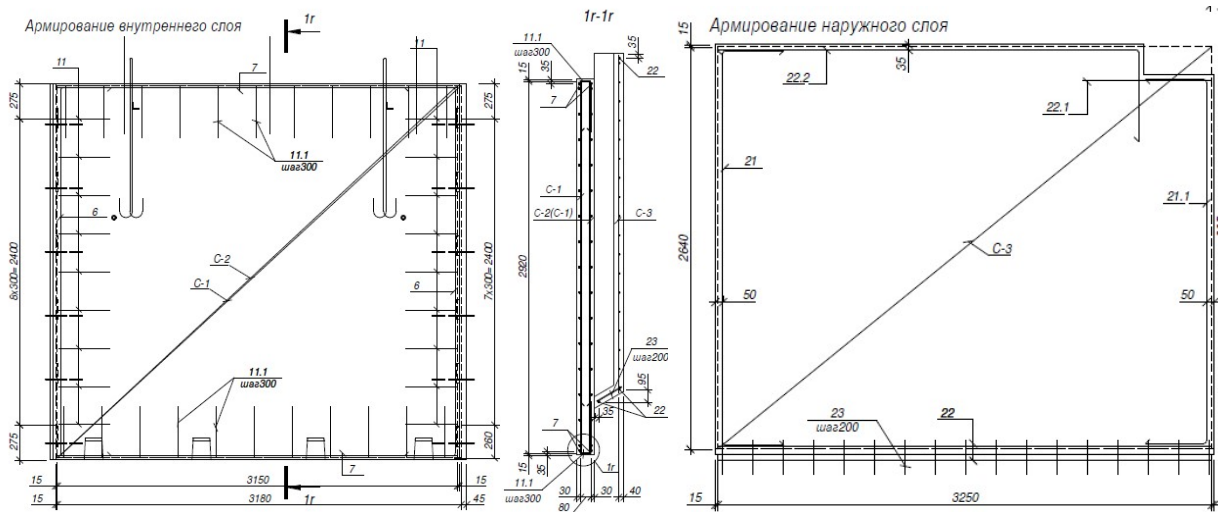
Пример армирования несущей внешней стеновой панели подвального этажа.
